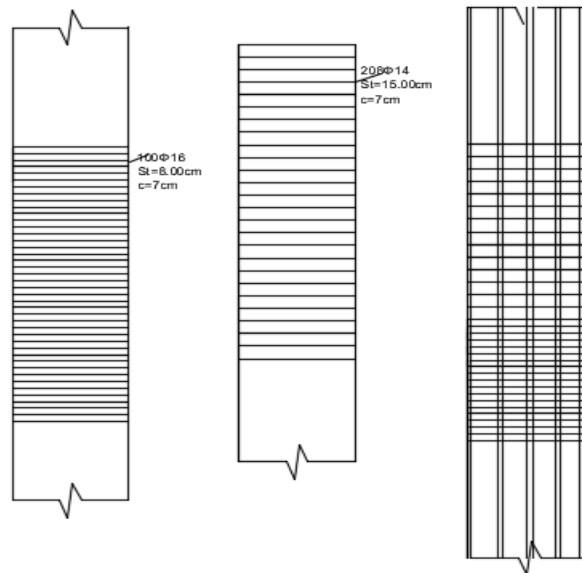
Schéma de ferrailage transversal d'une rangée de pieux
